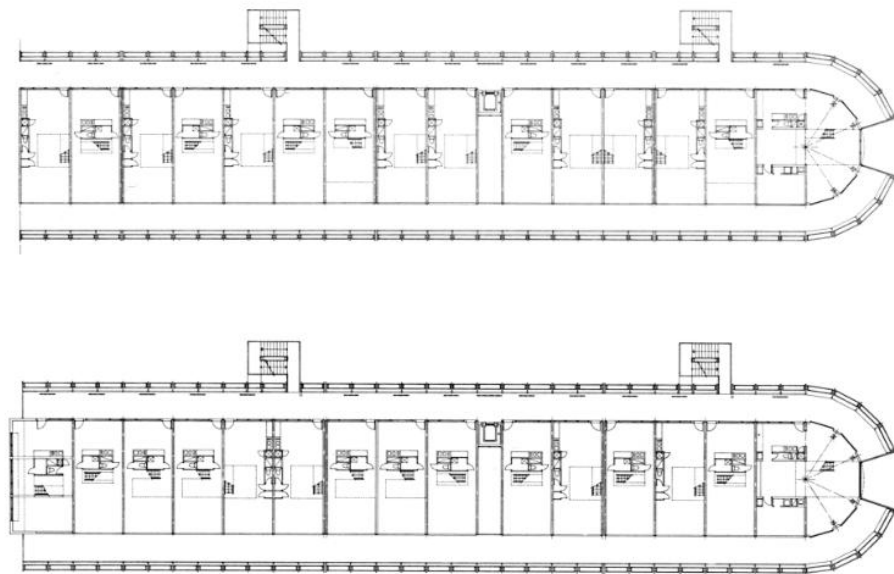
Planta Piso tipo das Unidades Habitacionais.
